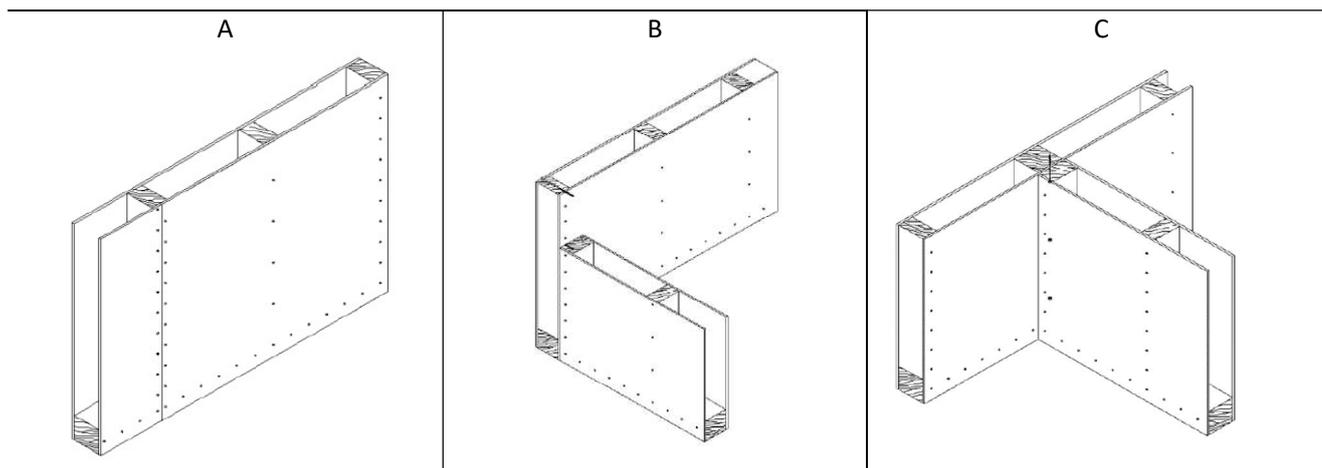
Soluzioni per il collegamento verticale tra pareti intelaiate. A Giunzione dei fogli di rivestimento di una parete intelaiata in corrispondenza di un montante B Collegamento d'angolo con viti, C Collegamento d'incrocio con viti incrociate. In alternativa in questo caso le viti possono essere inserite dritte dalla parete esterna.
